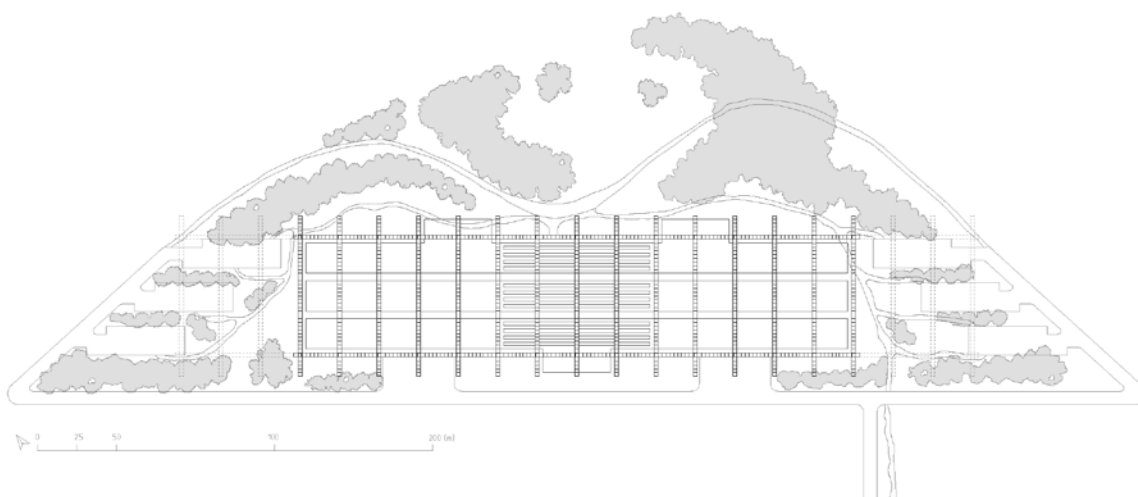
Planta del complejo de los laboratorios NAPP. Fuente: Elaboración propia.
